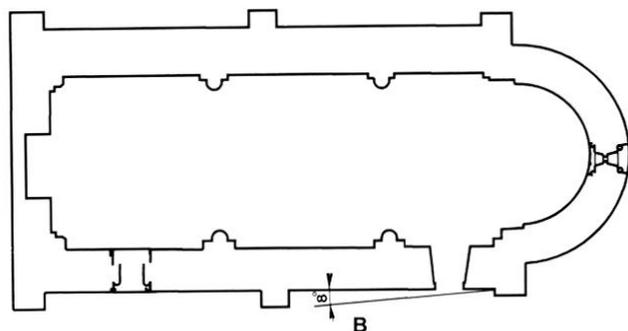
Plan de l'église Saint-André : b) implantation générale.
